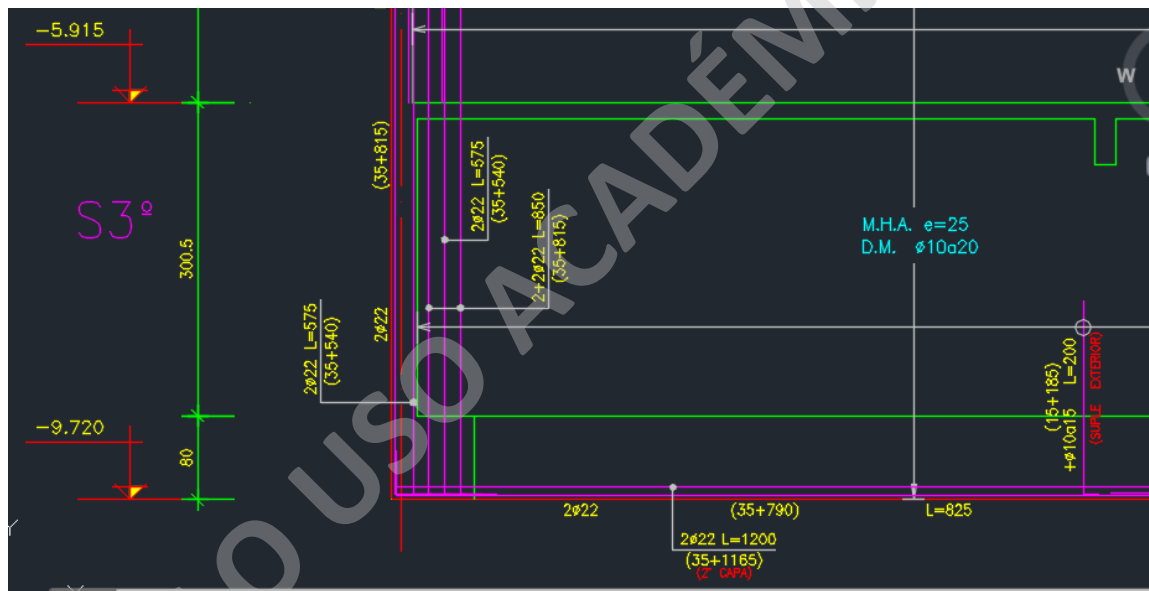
Detalle plano de cálculo de ejemplo, elevación de muro. Obtención propia
